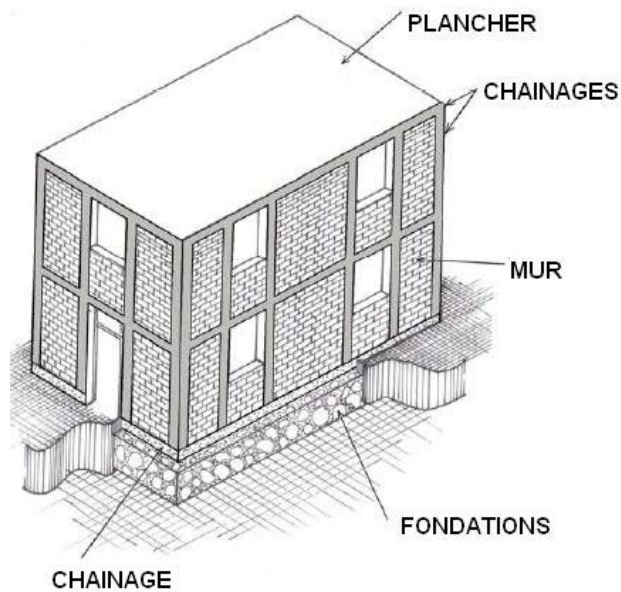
Construction en maçonnerie chaînée avec plancher en béton armé
